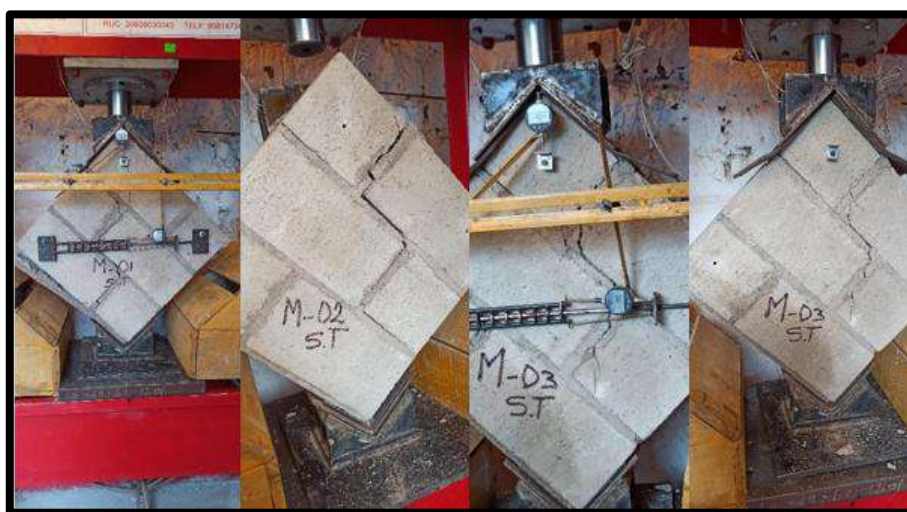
Formas de falla de los muretes M – 01, M – 02 y M - 03
